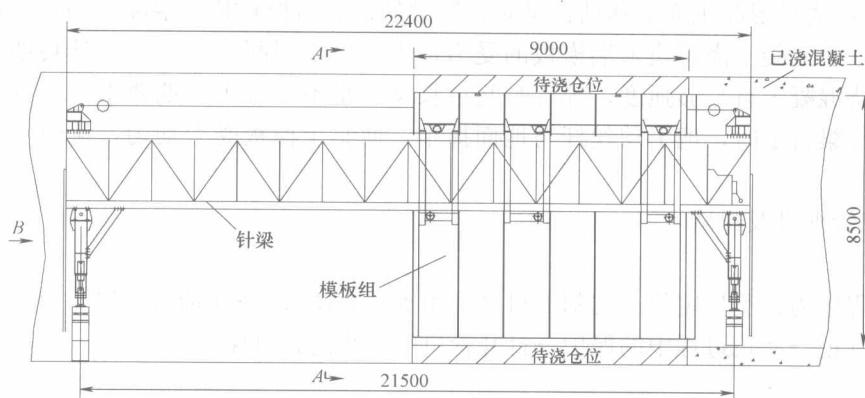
针梁钢模结构布置图 (单位: mm)
